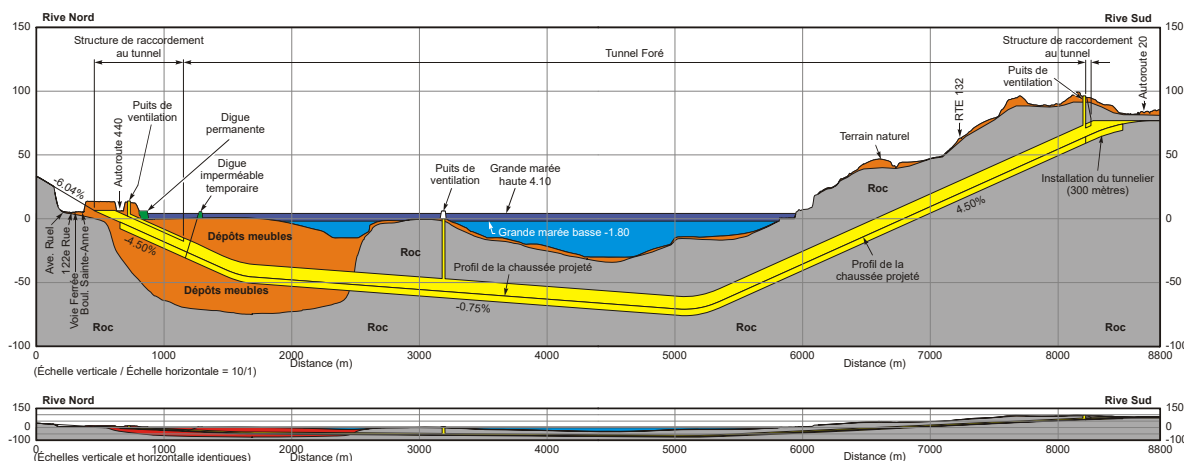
Profil longitudinal du tunnel dans le site (adapté de MTMDET 2016)
